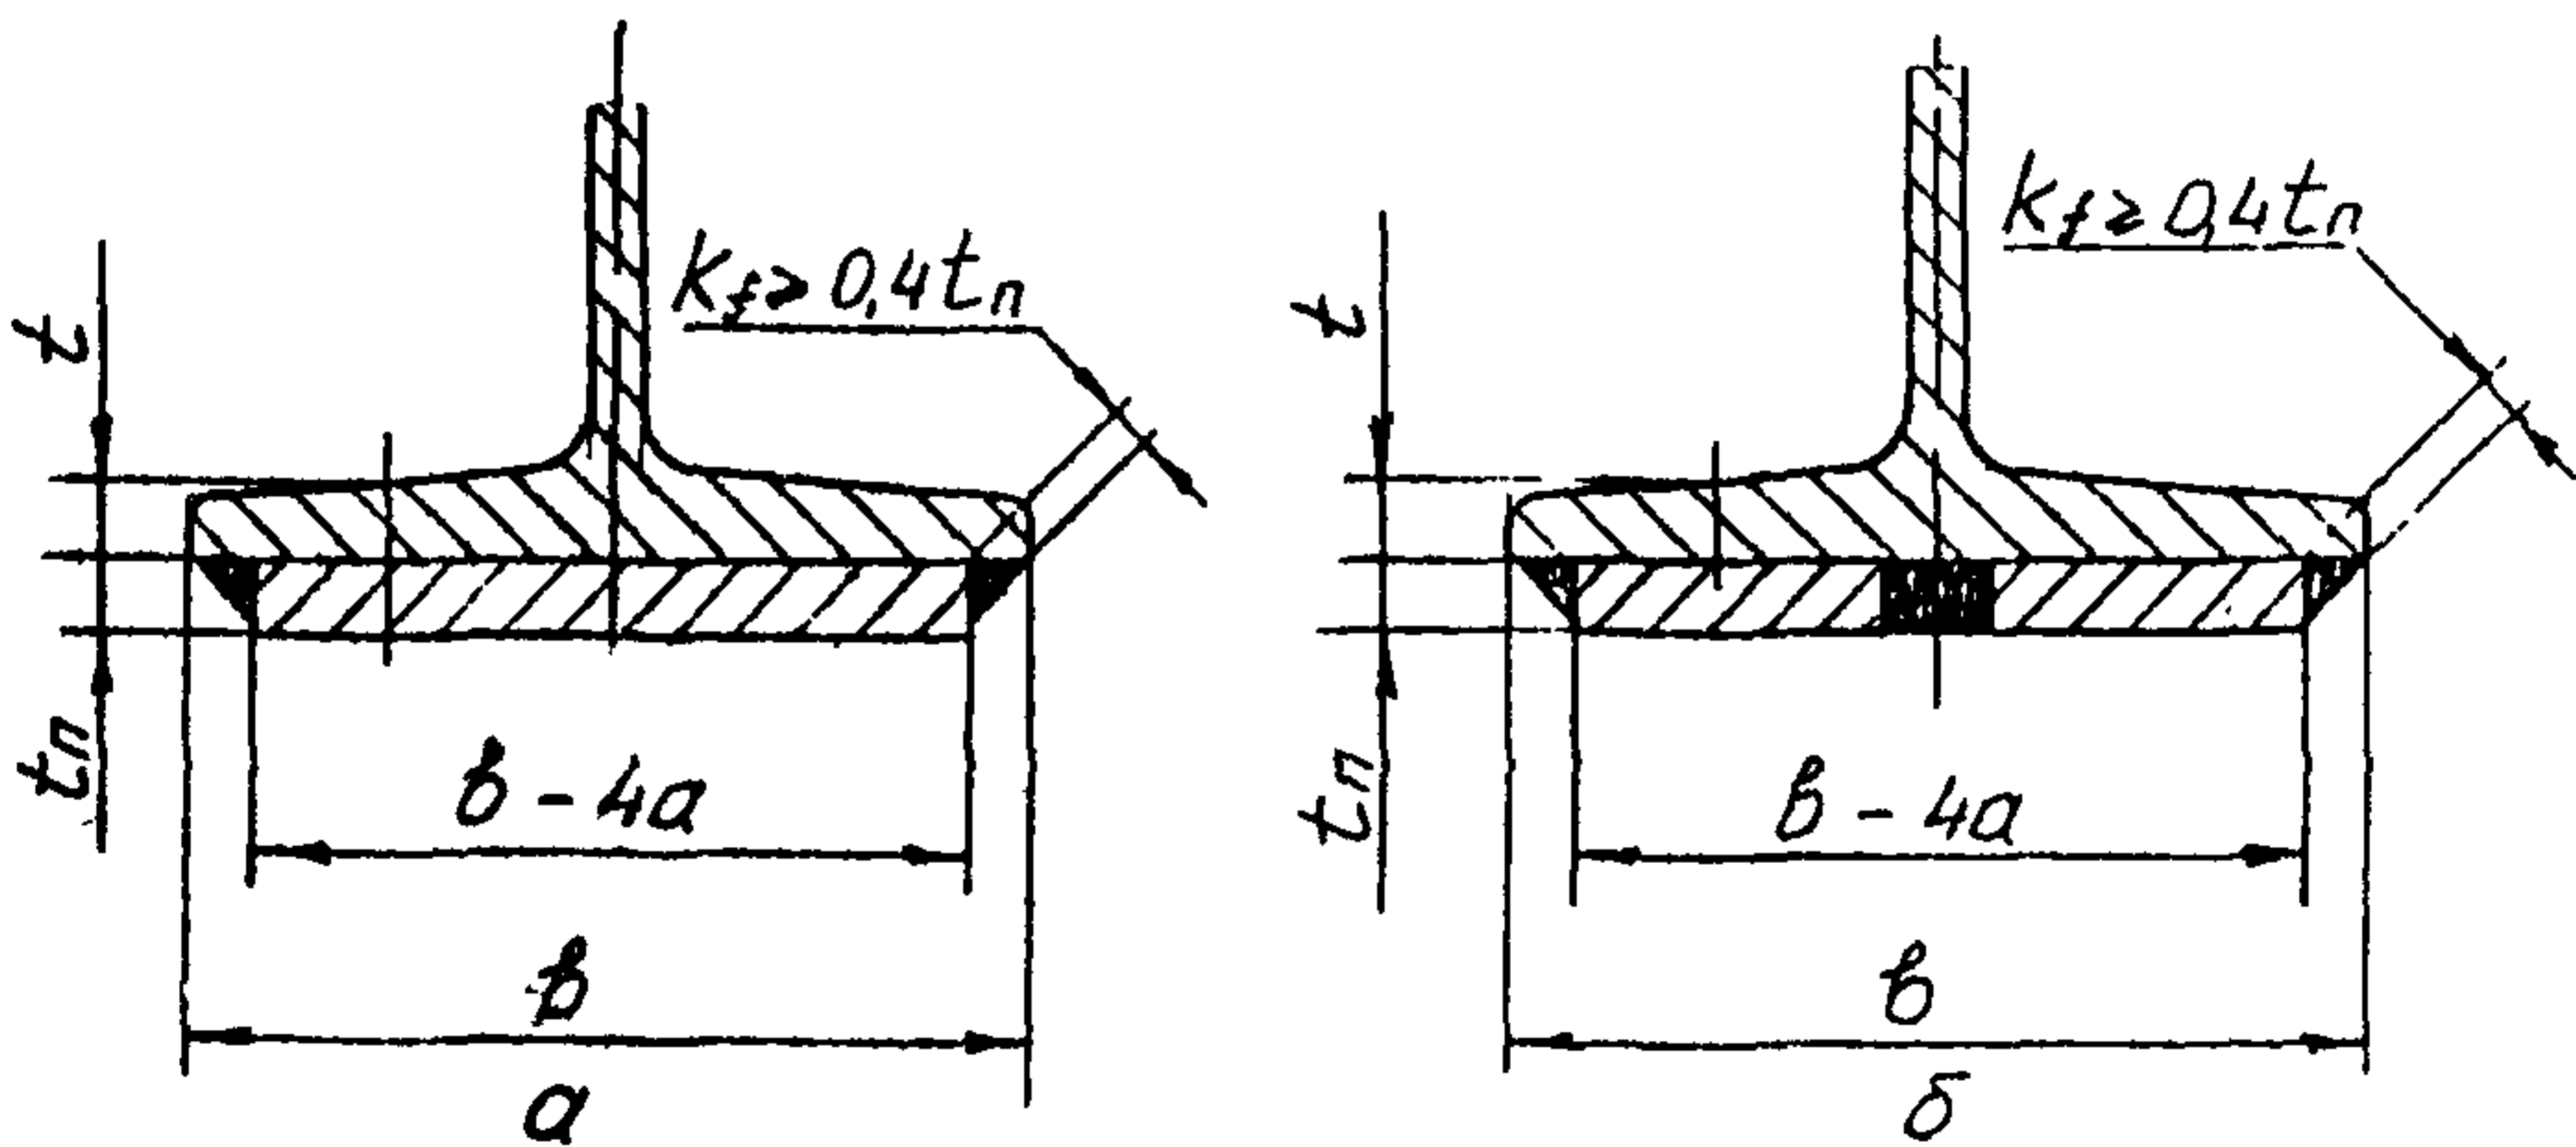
Усиление нижнего пояса подваркой полосы
